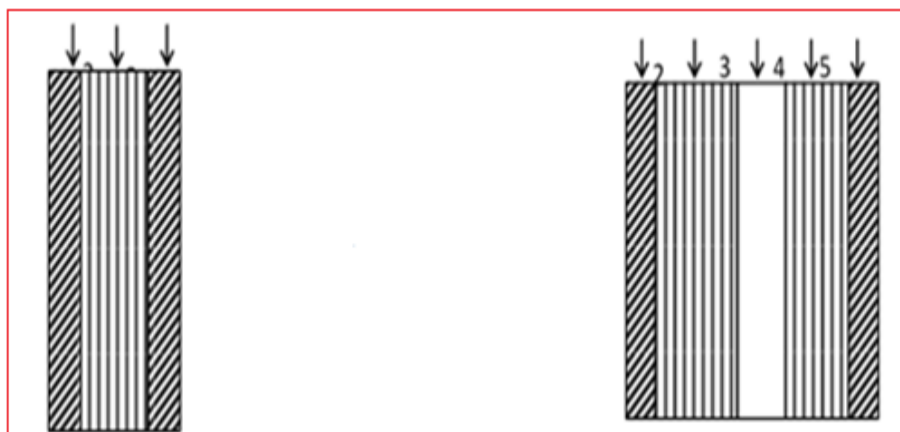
Coupe transversale d'un mur extérieur et intérieur
